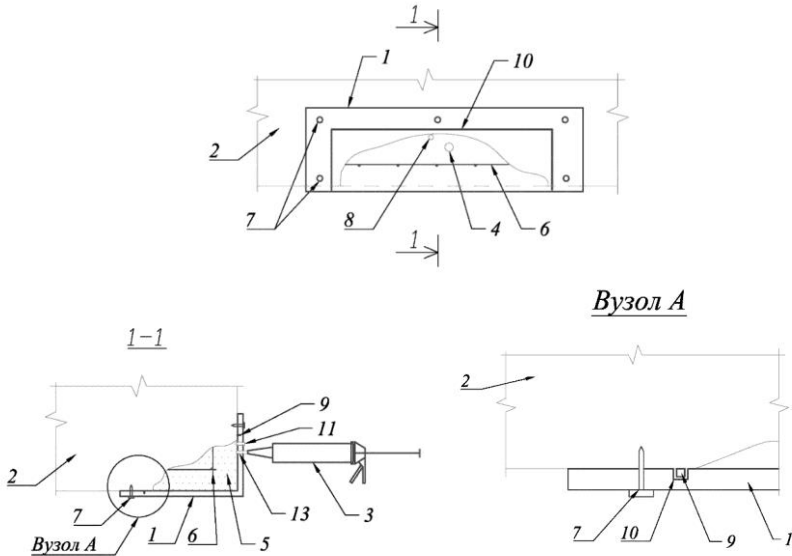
Схема подавання суміші в опалубку змонтовану на кут конструкції, що відновлюється: 1 – опалубка; 2 – залізобетонна конструкція; 3 – шприц для подачі суміші; 4 – отвір для подачі ремонтної суміші Ø8 – 10 мм; 5 – ремонтна суміш; 6 – оголена арматура; 7 – анкерне кріплення; 8 – отвір для випуску повітря Ø 6 – 8 мм; 9 – гумовий ущільнювач; 10 – паз; 11 – гнучка трубка для випускання повітря; 12 – гумовий шланг
